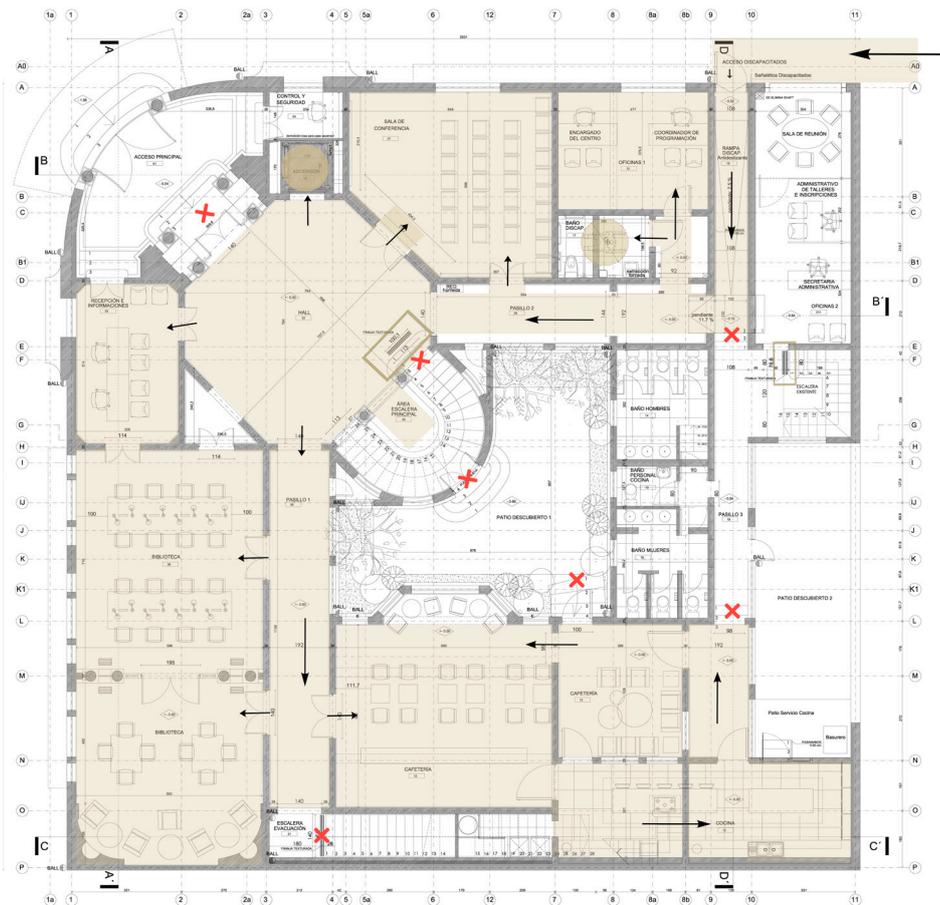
Plano de la ruta accesible del primer piso. Fuente: Elaboración propia en base a los planos que fueron facilitados por la Dom, 2022.
